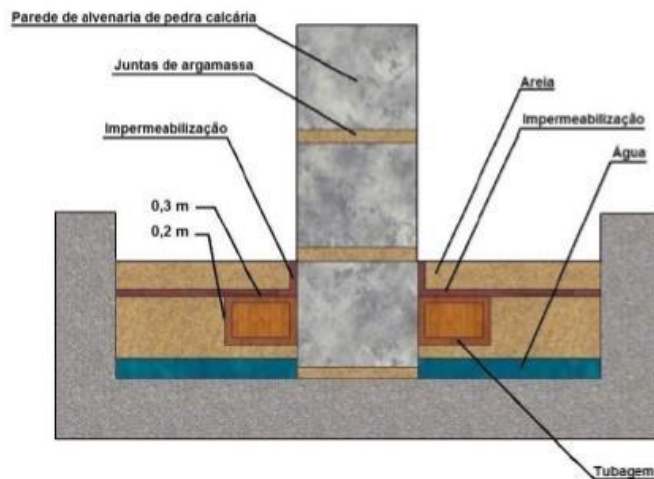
Configuração 2B – Impermeabilização do sistema de ventilação no paramento superior [13]
